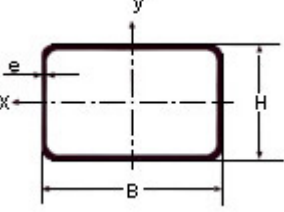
Tubos Estructurales de sección cuadrado para el CO
